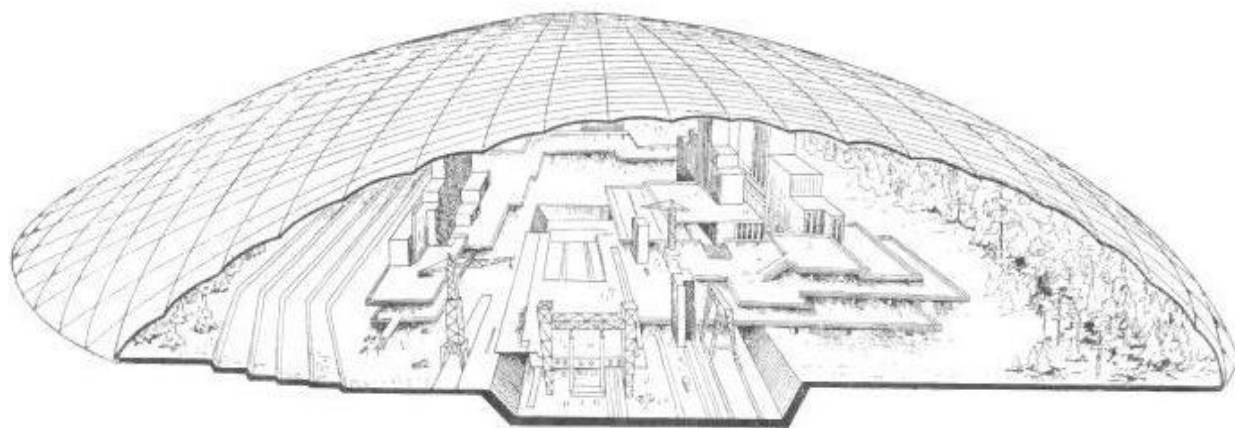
Общий вид воздухоопорной конструкции покрытия города
